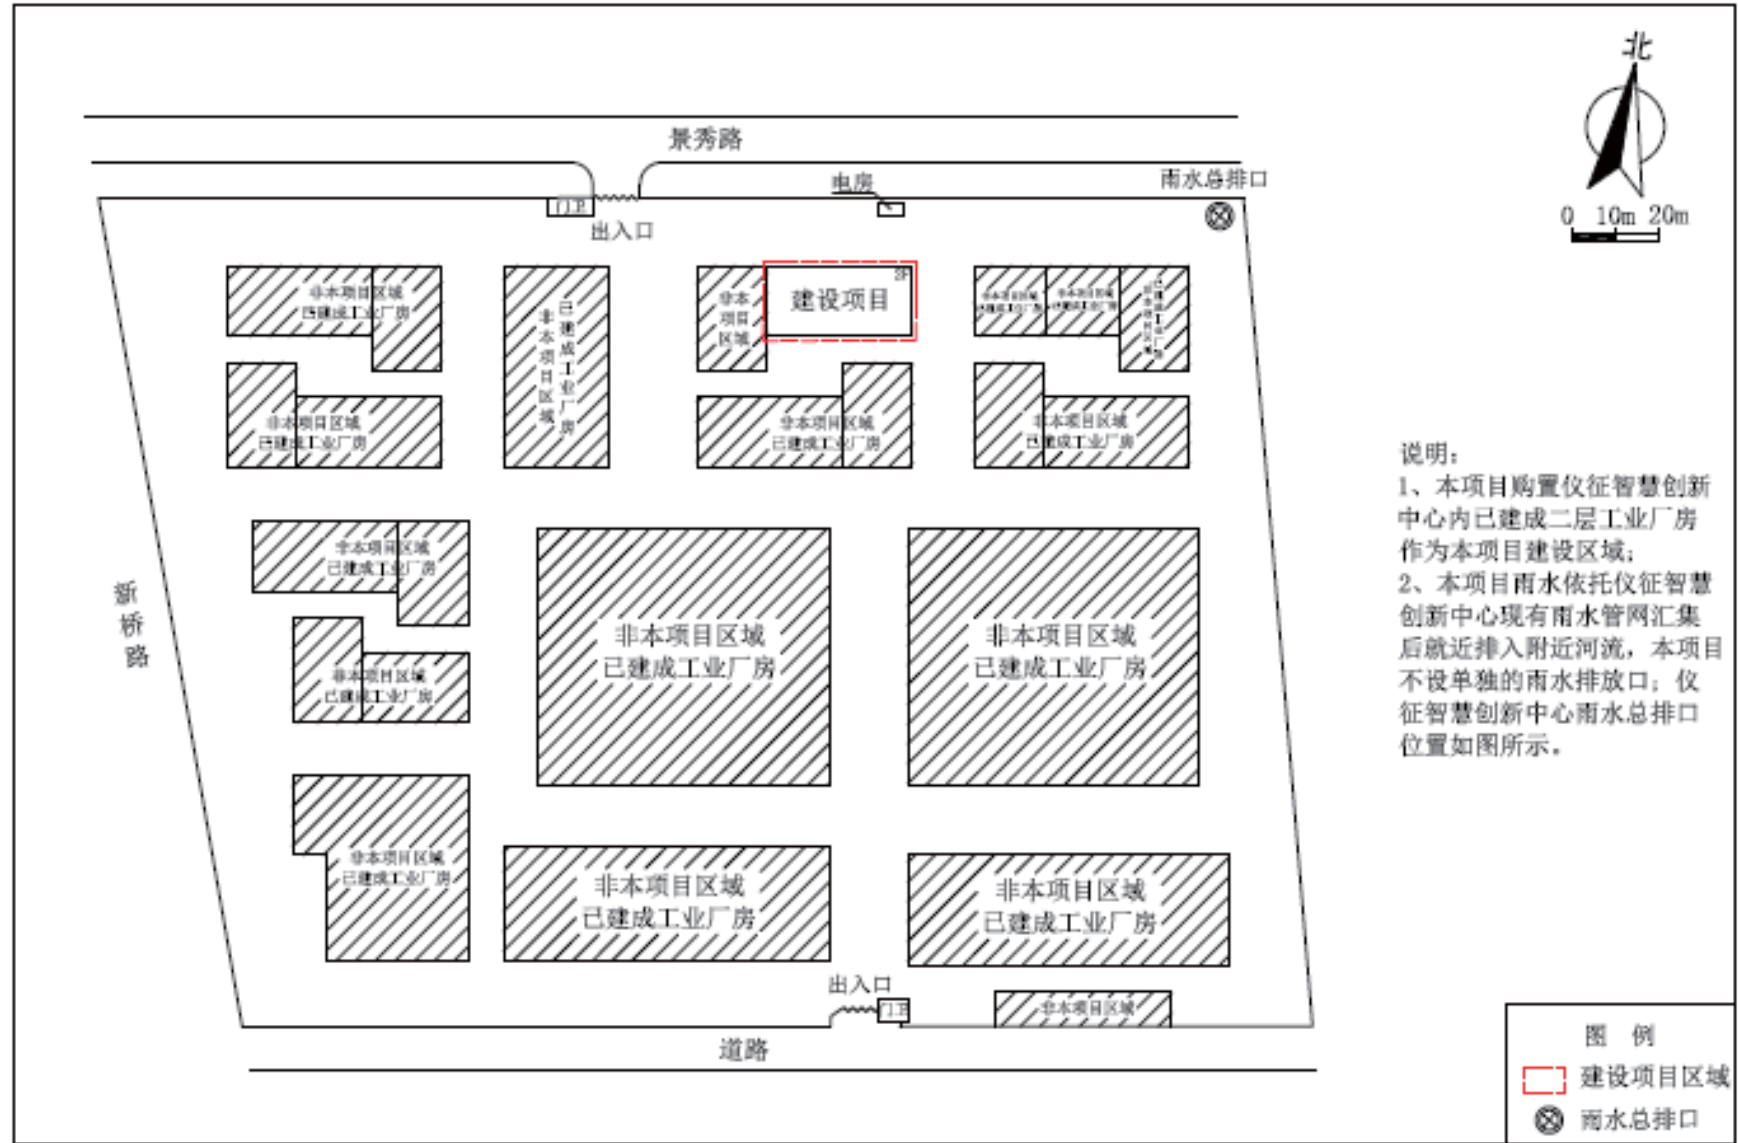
建设项目厂区总平面布置图（实际位置与环评申报基本保持一致）
